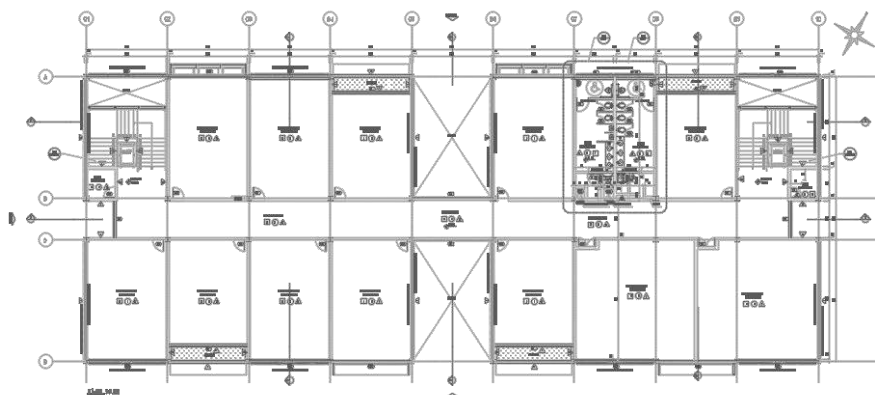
Planta baixa 4º pavimento prédio 20. Fonte: Adaptado de CEFET-MG, [201-].
